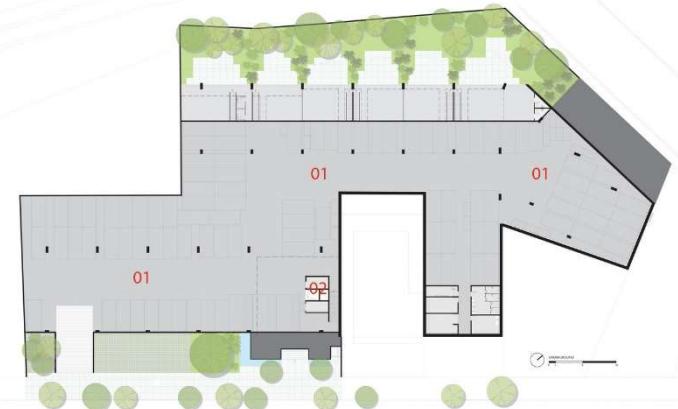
Planta Baixa Subsolo (01 – Estacionamento | 02 – Circulação Vertical).
